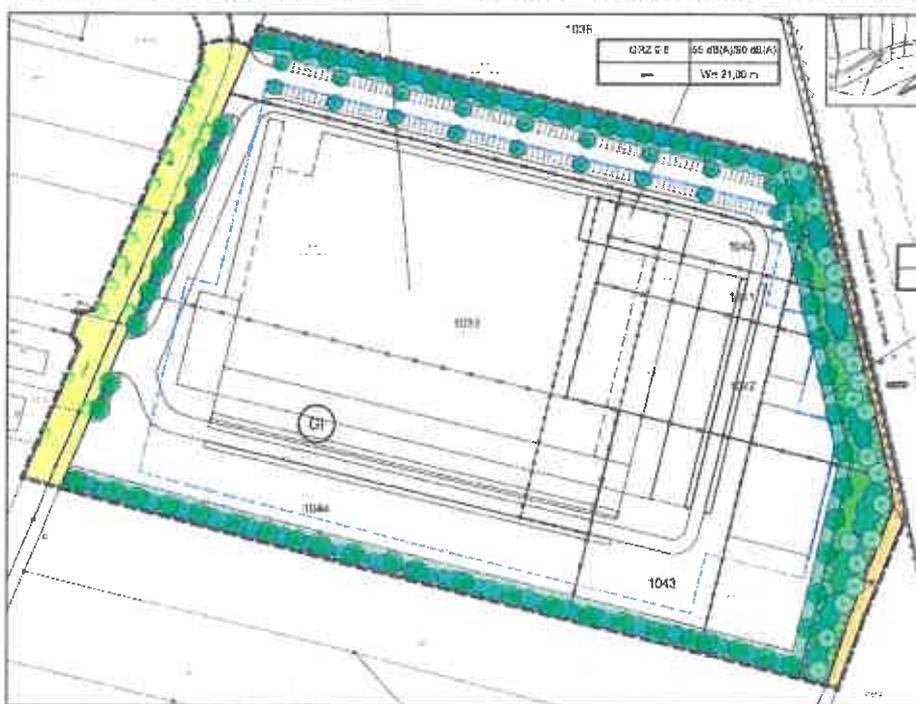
Lageplan des Bebauungsplans "Degernpoint - Ost"
